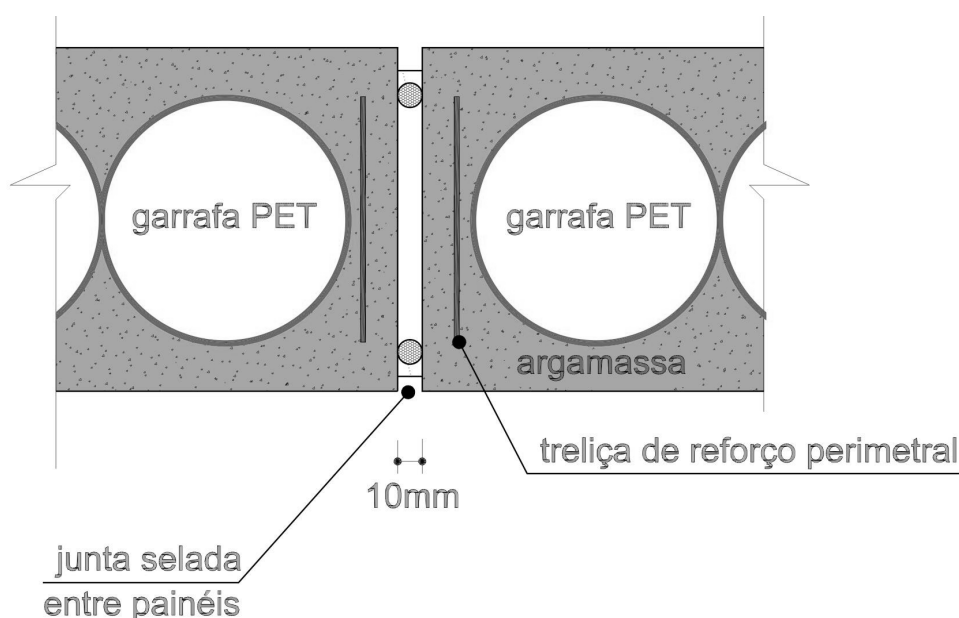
23: detalhe da união dos painéis de parede com junta de 10mm – planta baixa.
